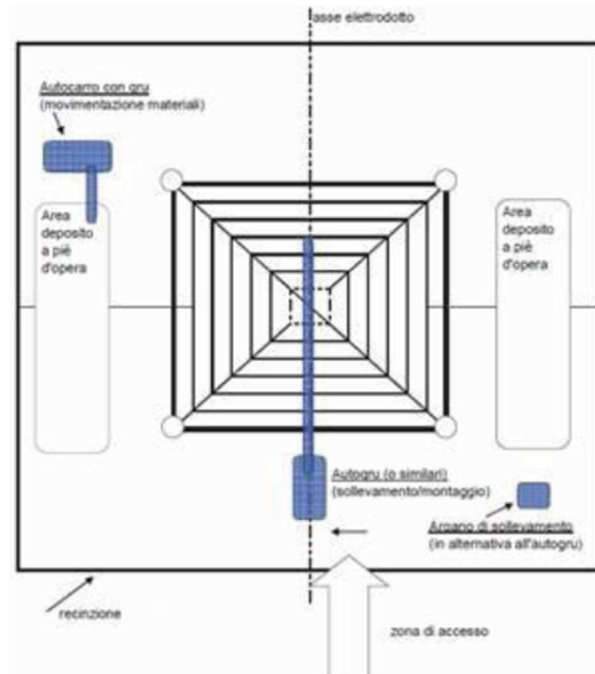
Planimetria tipologia del microcantiere nella fase di montaggio del sostegno
